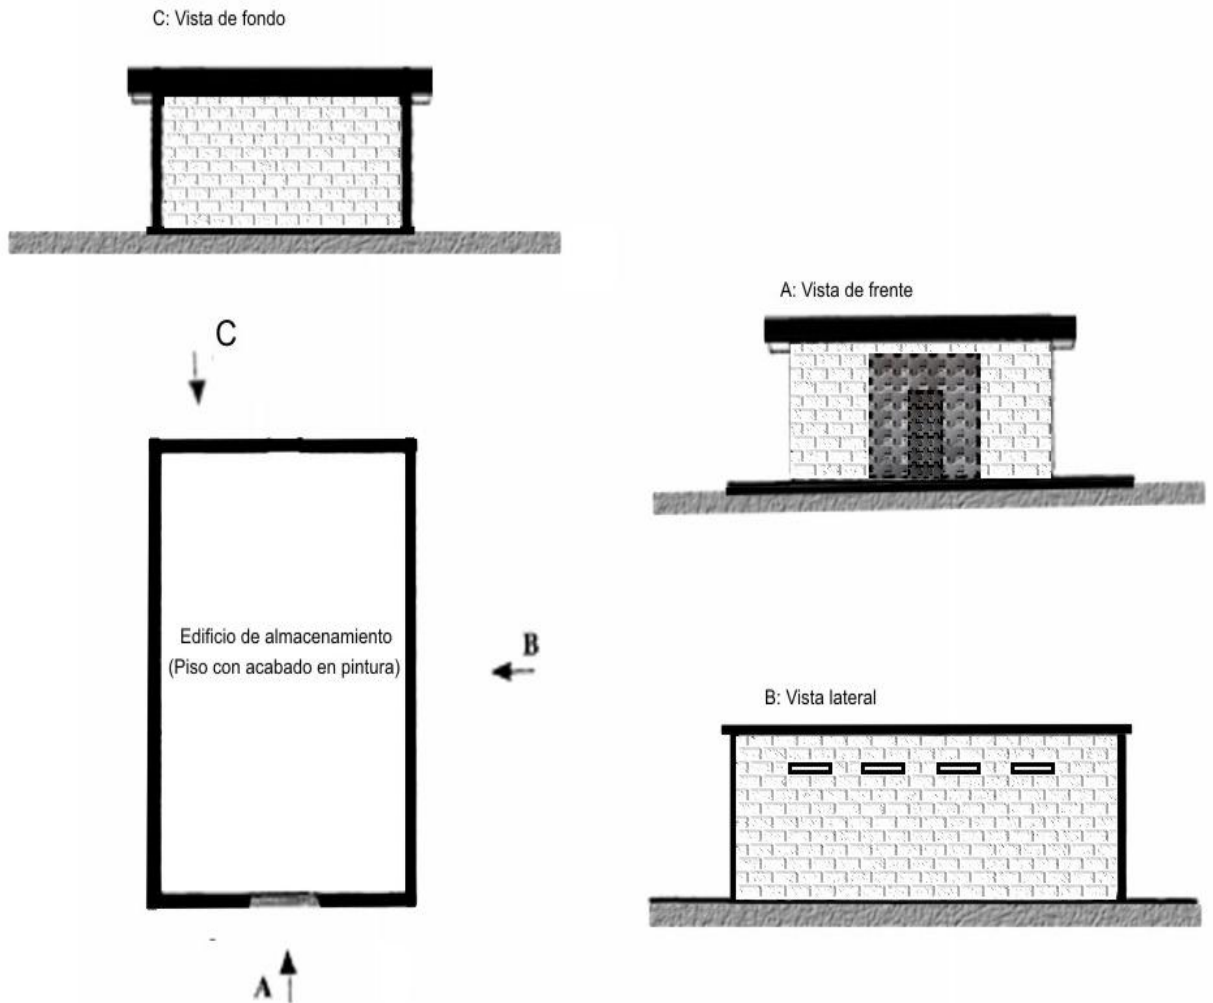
Fachadas de la Edificación de Almacenamiento.
